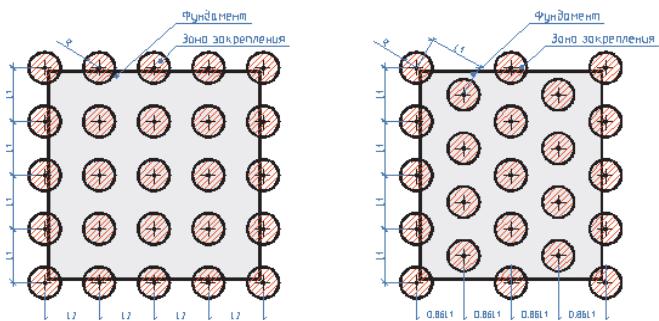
Частичное усиление грунта в плане для плитных фундаментов: а – закрепление плитного фундамента по линейной схеме при $L1 \approx L2$; б – закрепление плитного фундамента в шахматном порядке
